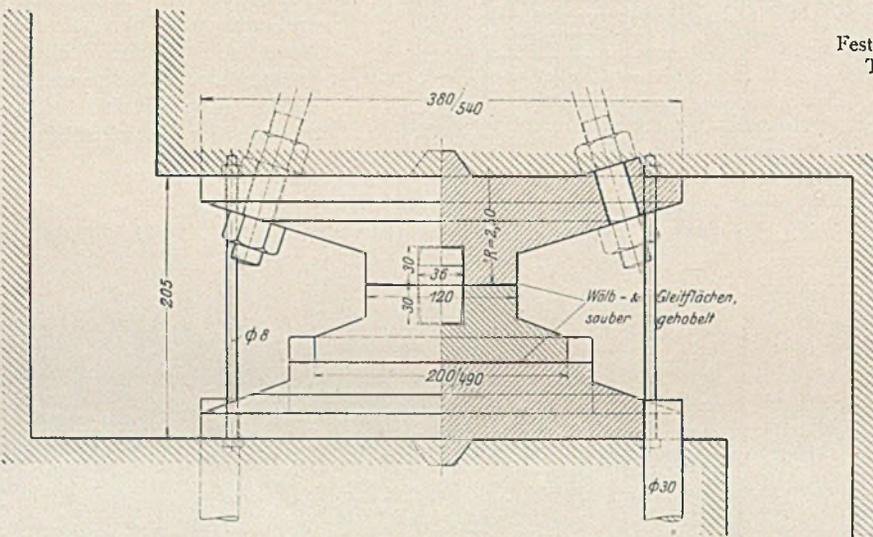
Bewegliches Lager des eingehängten Trägers als Stahlguß-Gleitlager.
